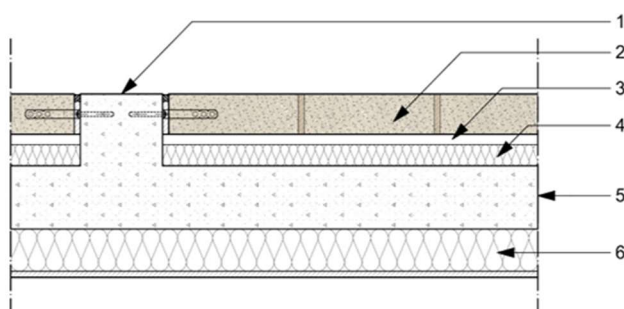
Cas B - Exemple avec ossature béton et ITE en panneaux enduits
